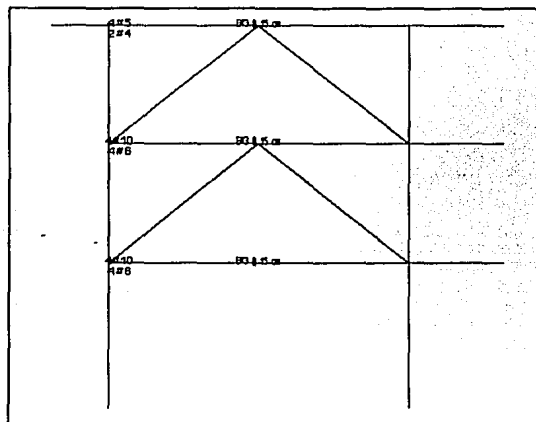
Armados en las vigas del eje 3, modelo 4, Q=2
